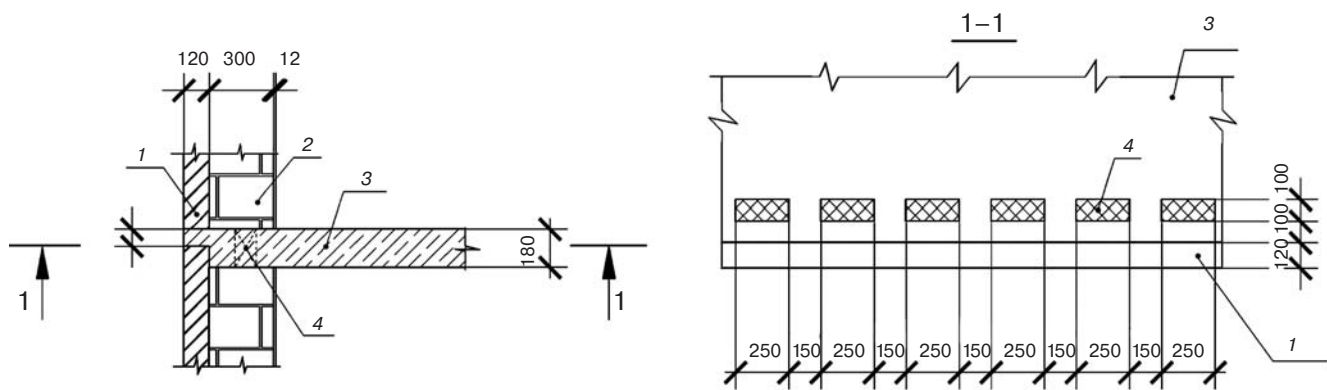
Узел сопряжения монолитного железобетонного перекрытия с перфорацией из пенополистирольных вкладышей со стеной: 1 – кирпичная кладка; 2 – кладка из пенобетона; 3 – железобетонный диск перекрытия; 4 – термовкладыши
